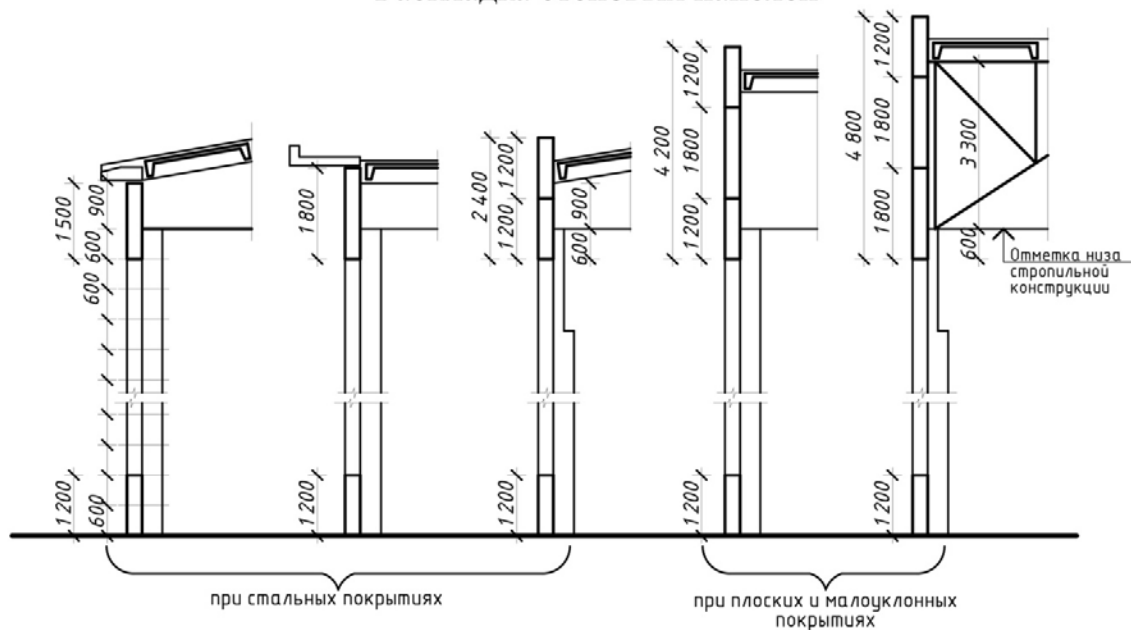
Примеры унифицированной раскладки стеновых панелей в одноэтажном здании.
